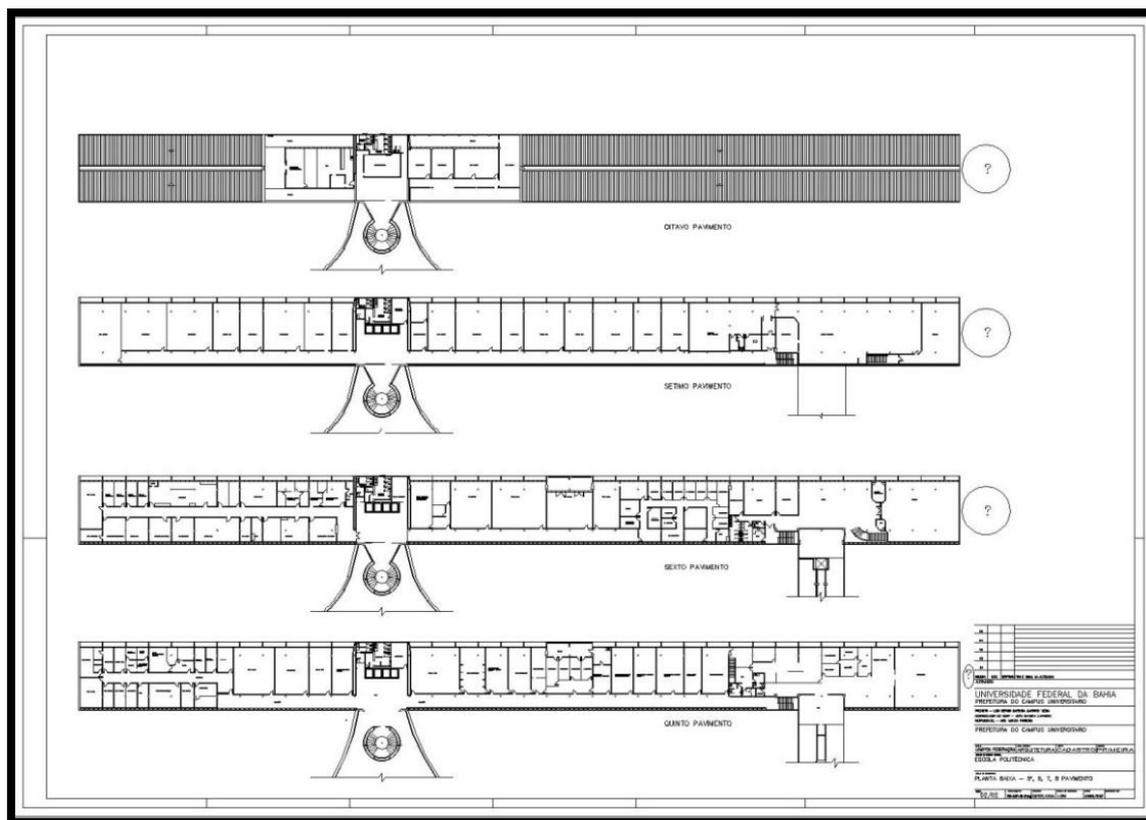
Planta Baixa dos Pavimentos 5-8 da Escola Politécnica (Junho/2003). Fonte: SUMAI, apud MAGALHÃES, 2020.
